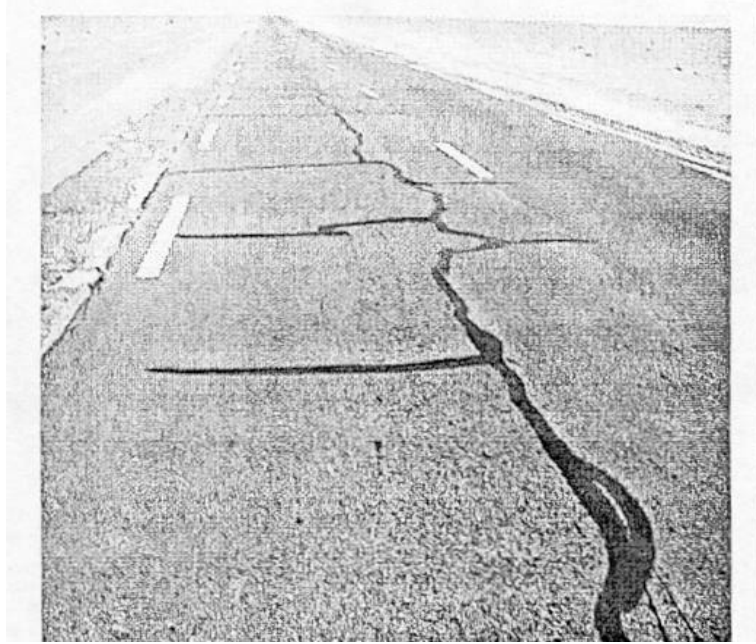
Remontée des fissures sur la section réalisée en BB (OUARGLA) [26]
